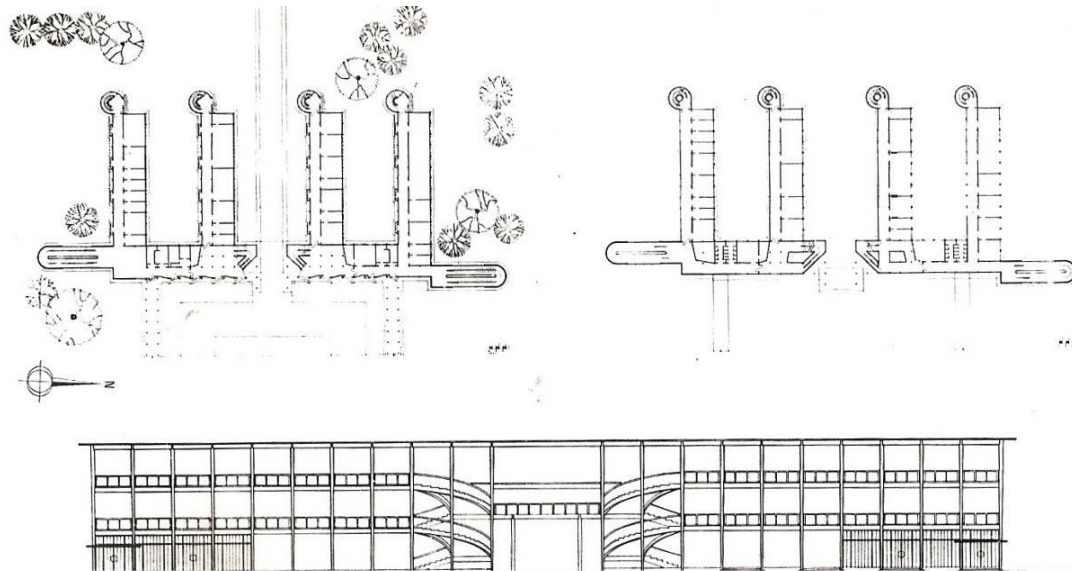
Grundriss und Ansicht einer zweiten Version des kammartigen Hauptgebäudes.
